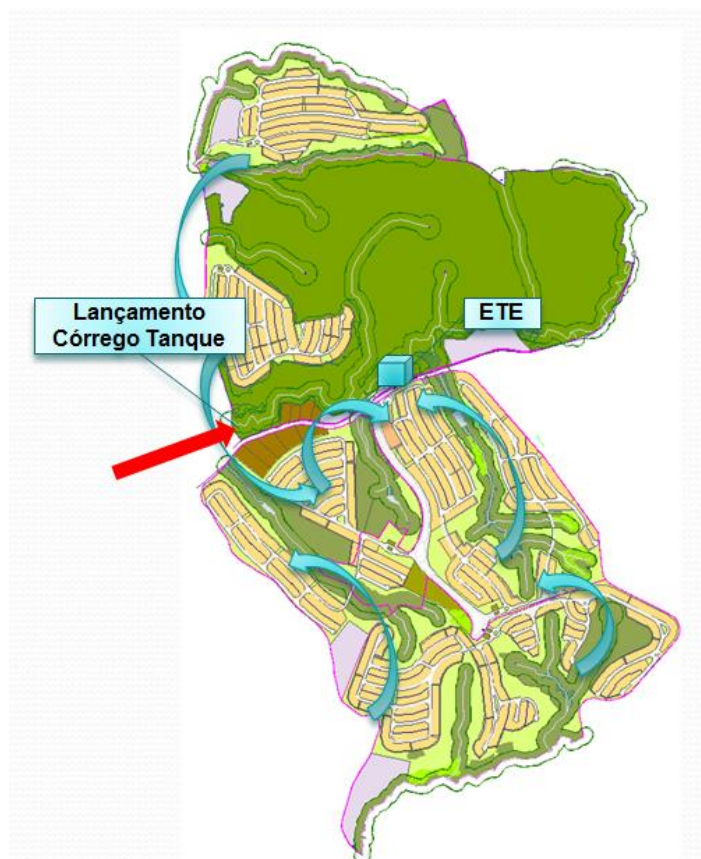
Alternativa Escolhida – Lançamento no Córrego Tanque
